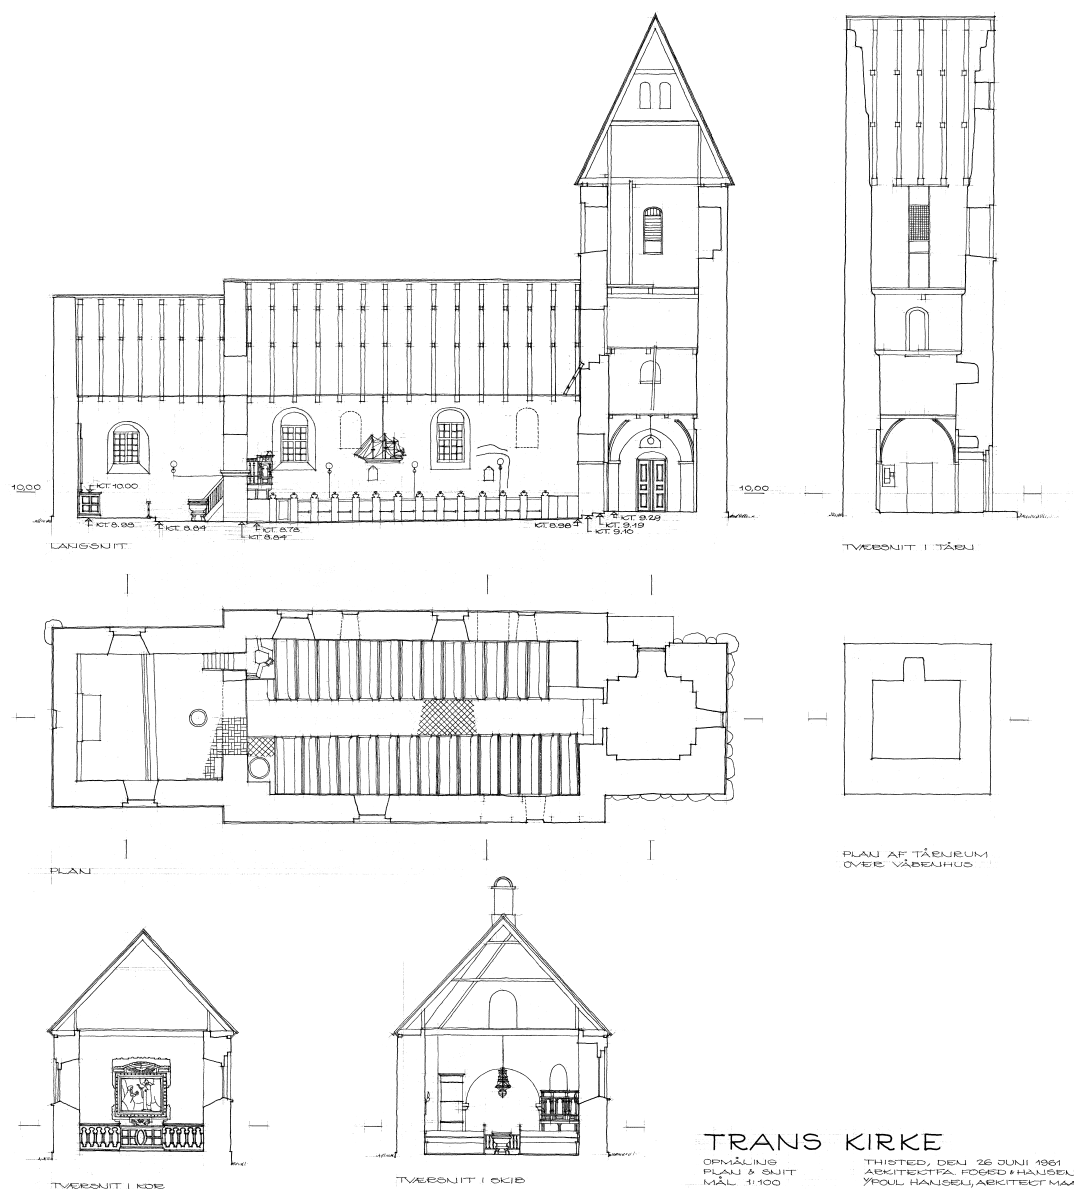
Plan og snit 1:300. Målt og tegnet af Poul Hansen 1961. Poulsen og Partnere, Thisted. – *Grundriss und Schnitt.
